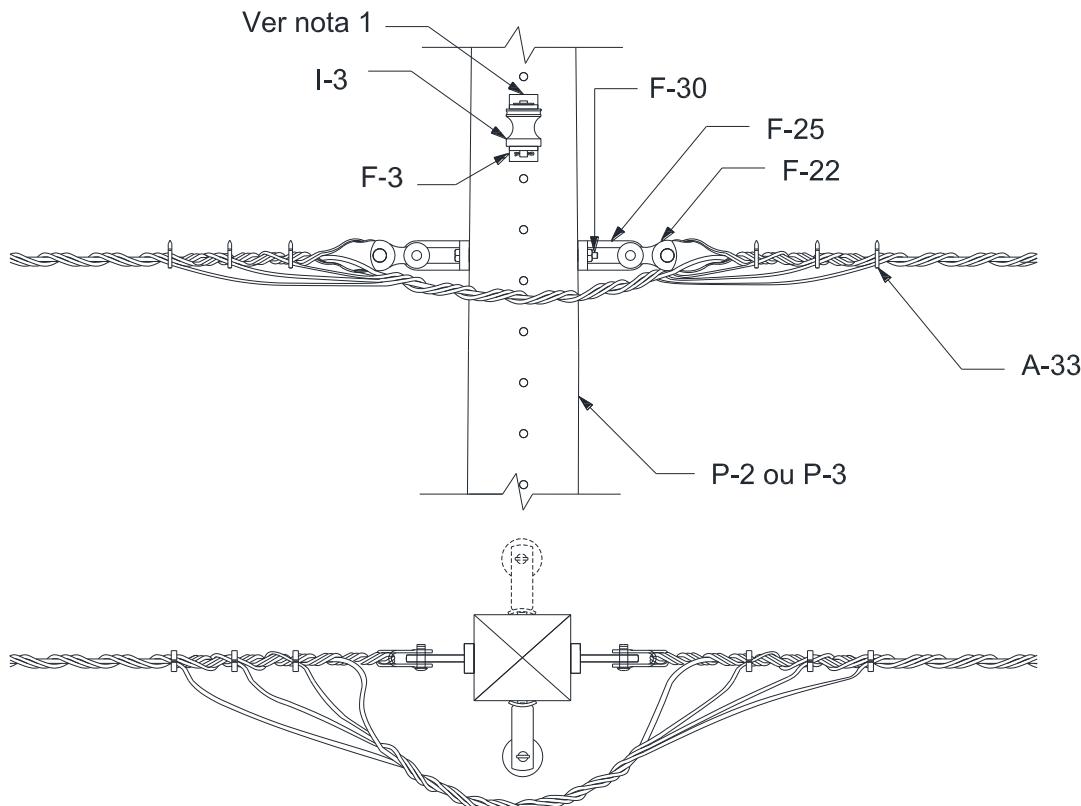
Estrutura ancoragem dupla – SI4 – Poste de concreto de seção DT ou madeira
